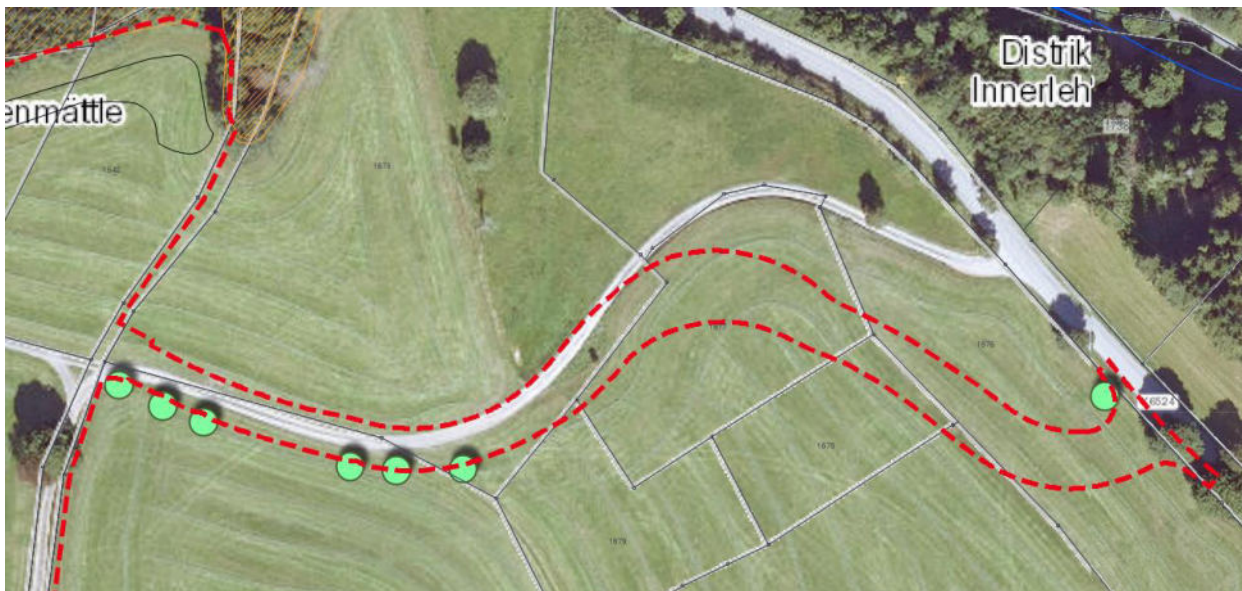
Baumpflanzungen entlang der neuen Zufahrtsstraße
